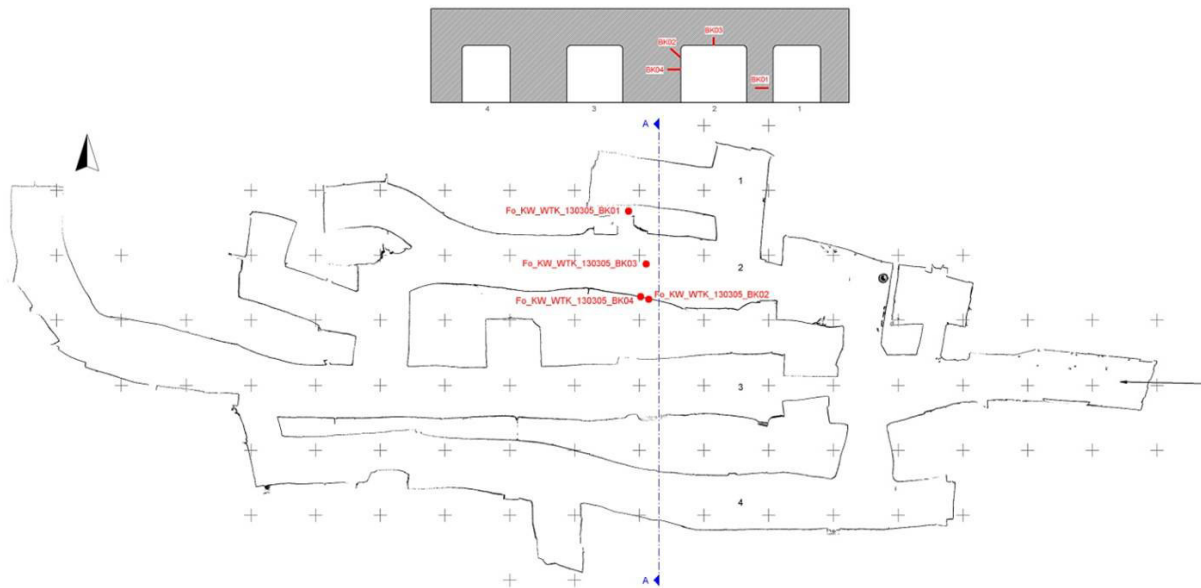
Grundriss Weiß-Tauben-Keller mit Lokalisierung der Bohrkernentnahmen.
